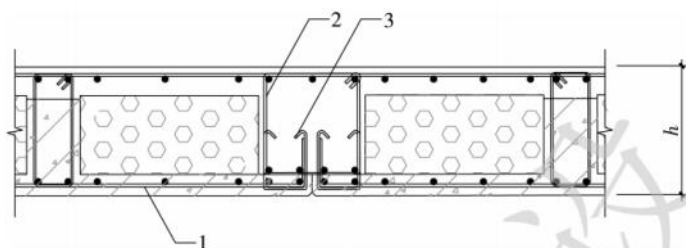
预制带肋底板空心楼盖抗劈裂钢筋示意
